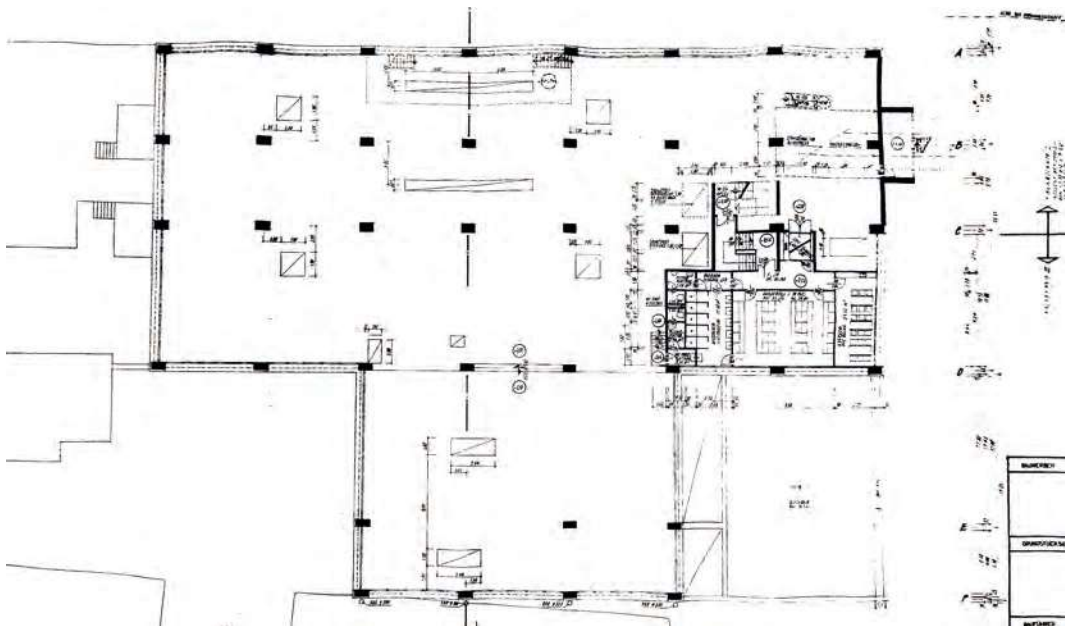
Grundriss Obergeschoss aus den Planunterlagen von 1966
